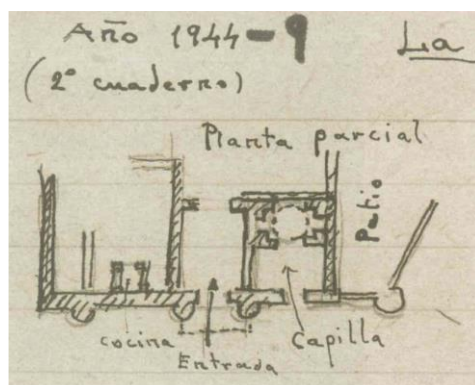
Planta de la entrada con la puerta de la capilla en la fachada principal. Pazo de Edra, Laiosa, O Incio, Lugo. Ídem.
